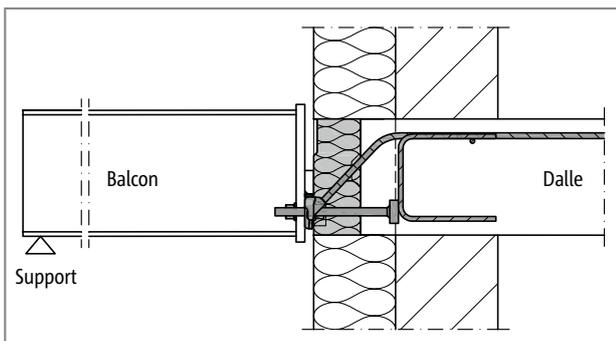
Schöck Isokorb® T type SQ : Grâce à la saillie du plancher, l'extérieur du corps isolant affleure l'isolation du mur, tout en tenant compte des distances par rapport aux bords latéraux
